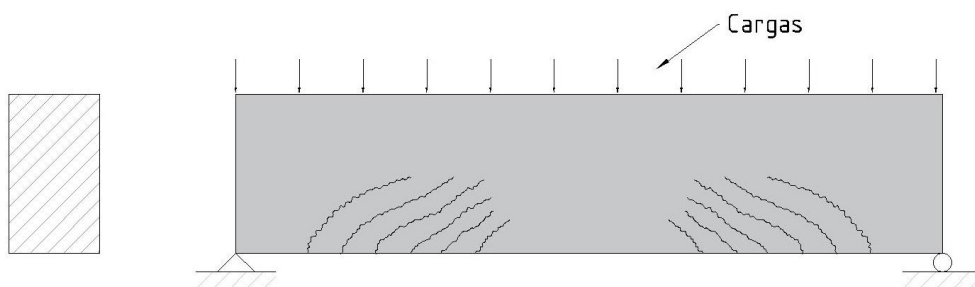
Fisuras por cortante y flexión (Carrasco Castro 2010)
